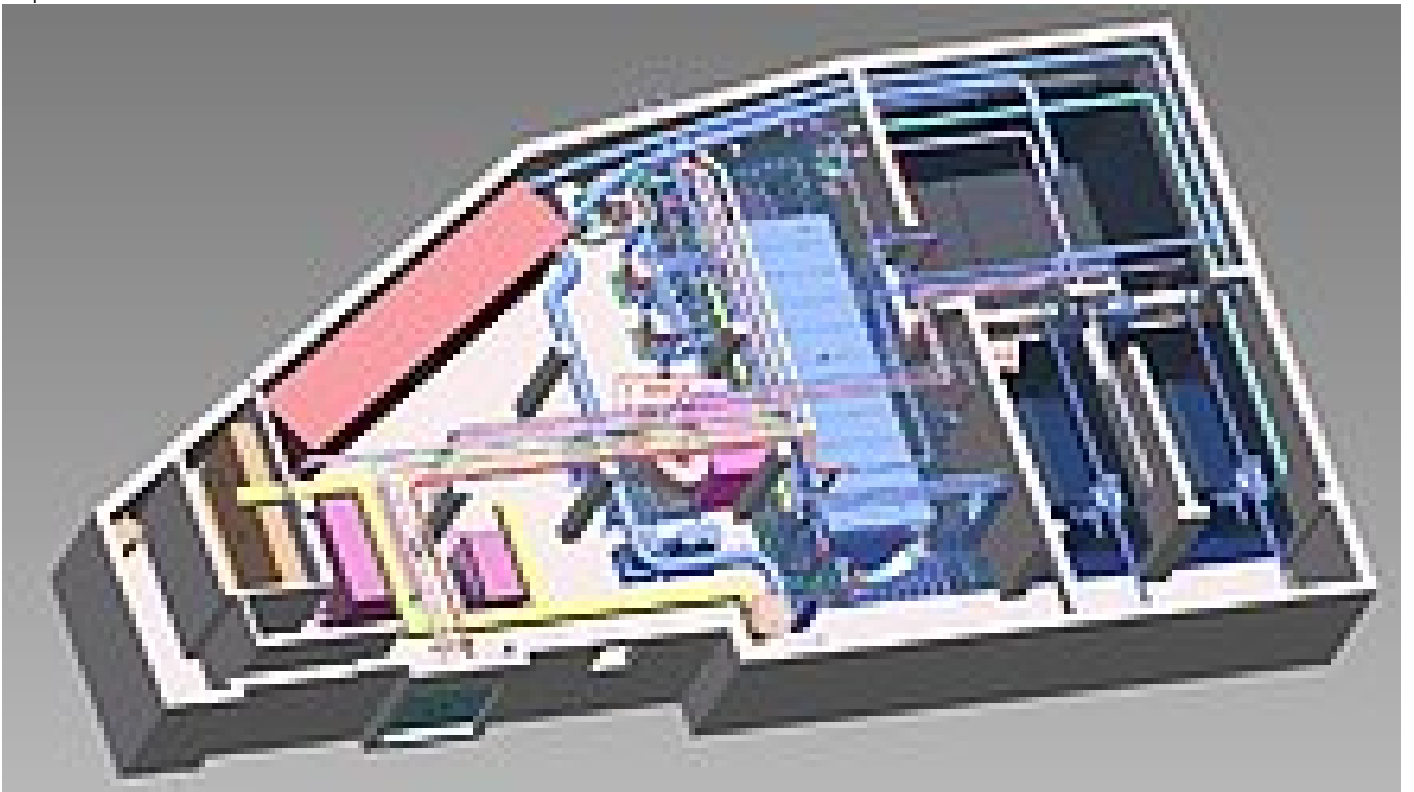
Übersichtszeichnung Abwasserreinigung Milchwerk Jäger
